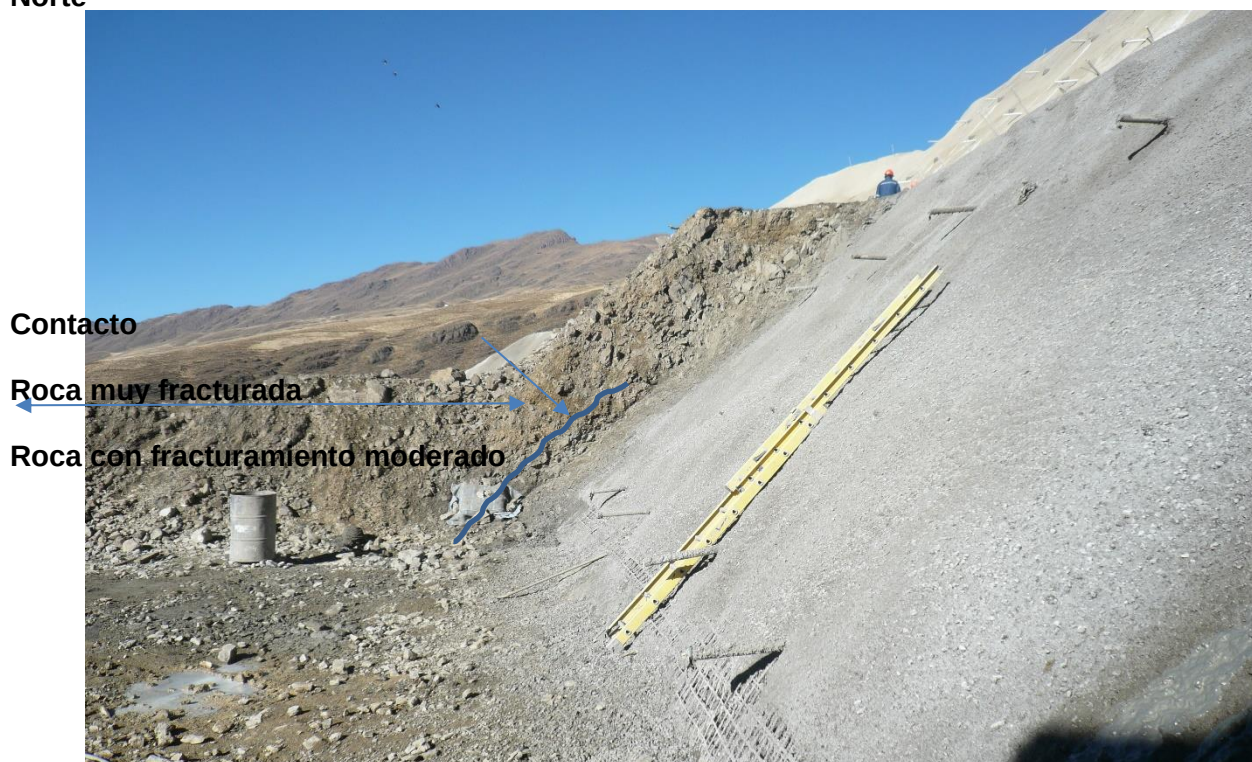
Afloramiento rocas talud comprendido entre cotas 3782-3792 ejes 2-6 sector Sud
